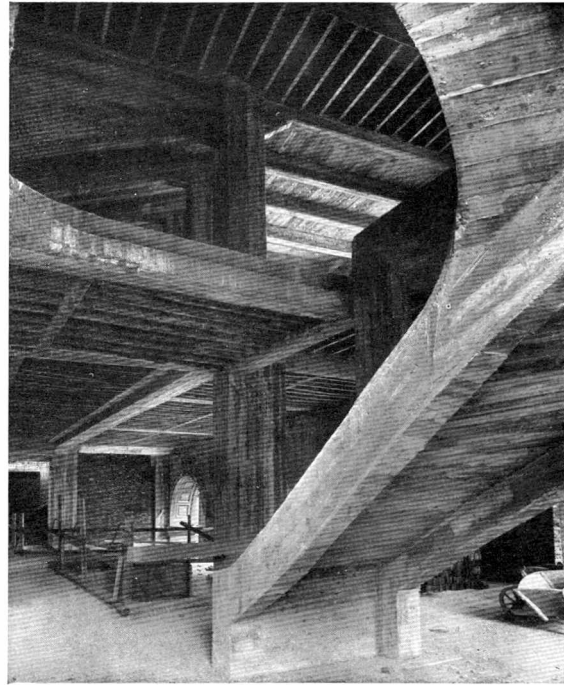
Ufapalast, Stuttgart. Treppe vom Parterre zum 1. Rang (Ludwig Bauer, Stuttgart). Phot. Dr. Lossen & Co.
